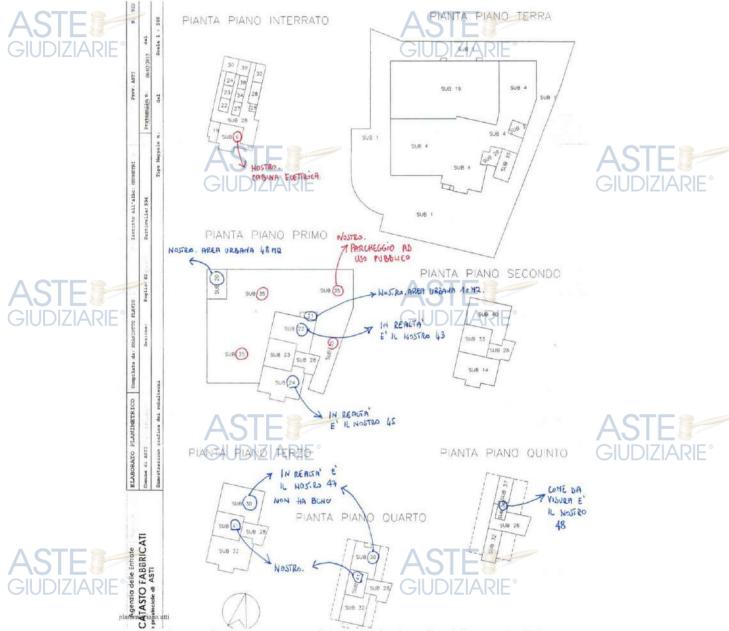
Incongruenze elaborato planimetrico del mappale 994
